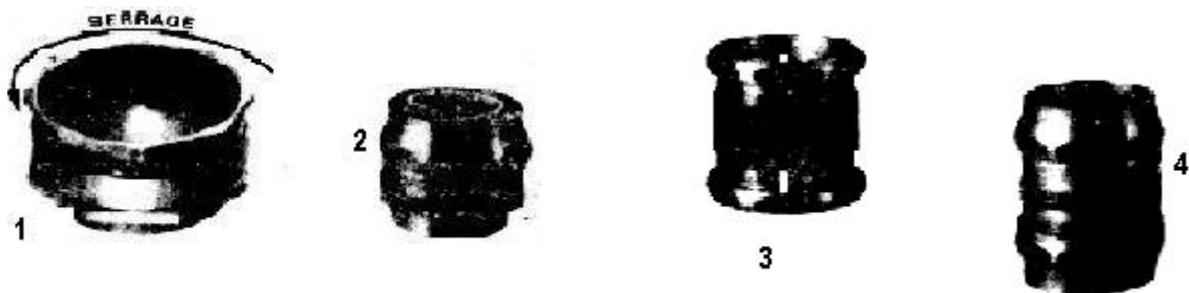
Les accessoires d'un conduit flexible « métallique »
